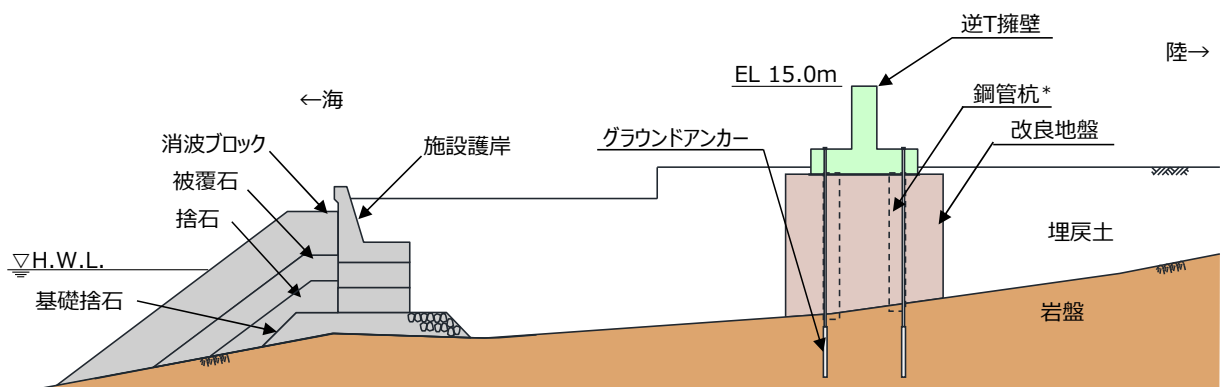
防波壁（逆 T 擁壁）の縦断面図
